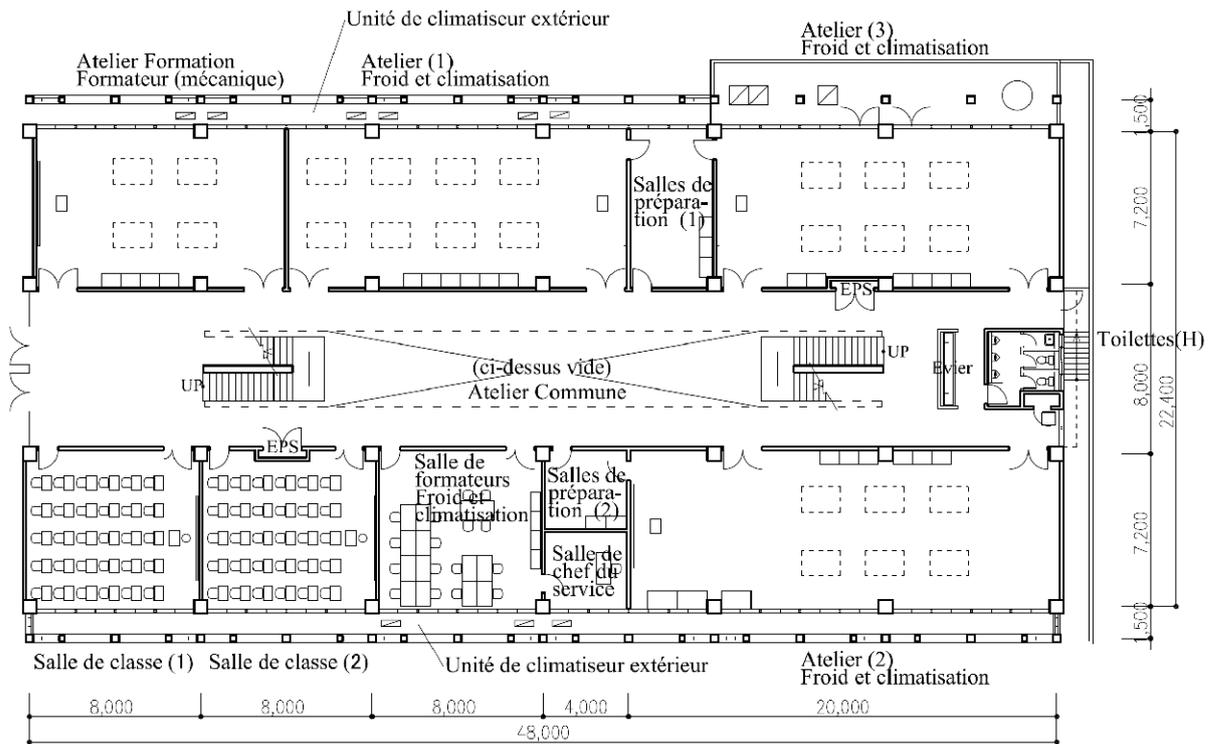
Bâtiment Pédagogique - Rez-de-chaussée
